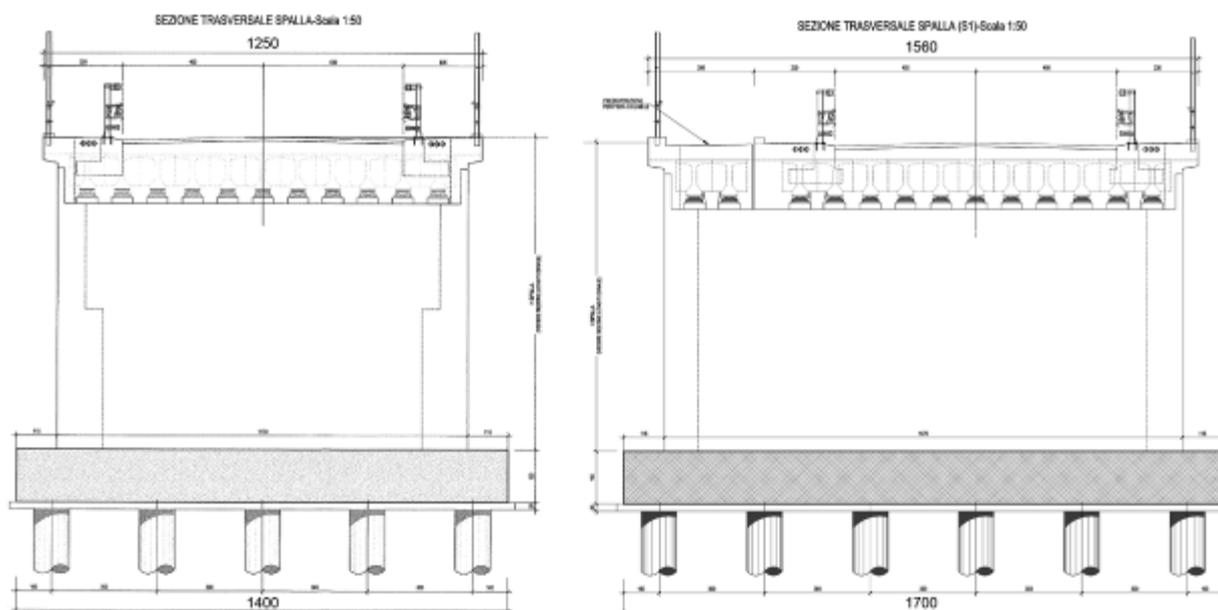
Contesto di analisi A - Progetto Definitivo - Viabilità Stazione Casanuovo – Tratto B –(evidenziato in rosso l'allargamento dell'impalcato)
